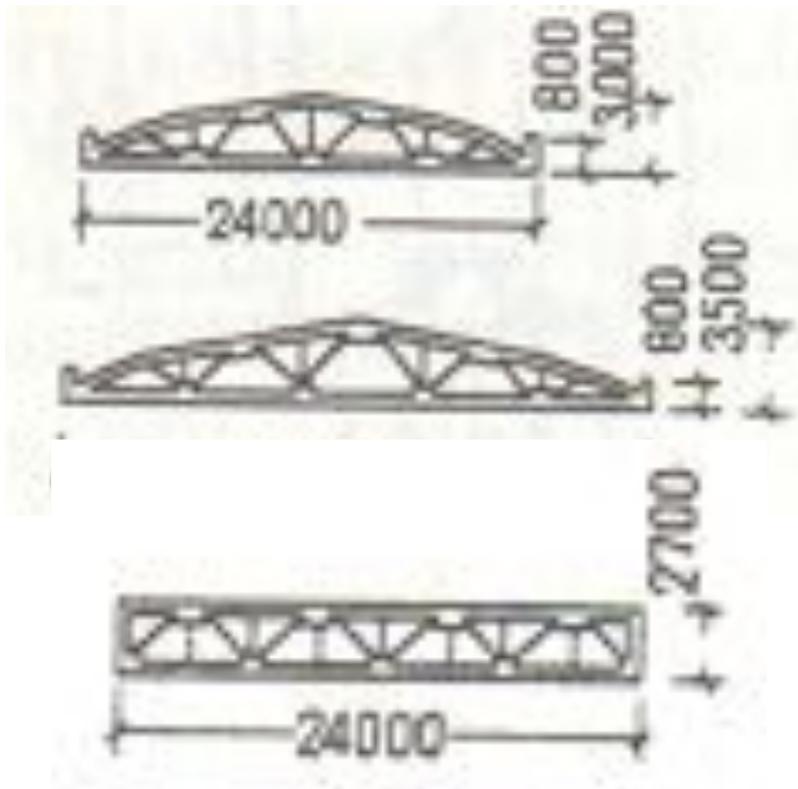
(а)- Унифицированные сборные железобетонные фермы а - сегментные; б - с параллельными поясами
